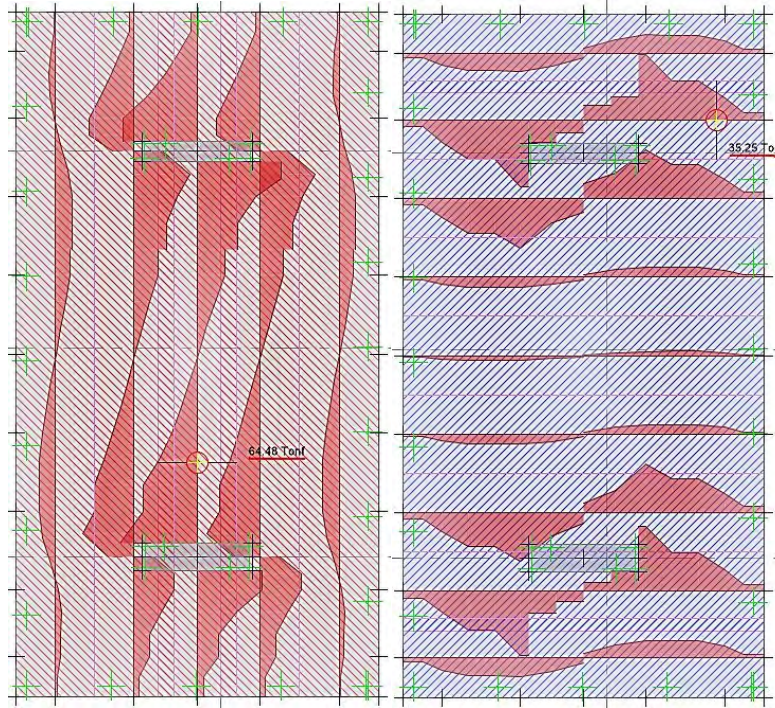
Fuerzas cortantes últimas a distancia "d" del elemento vertical, correspondientes a franjas de diseño longitudinales y transversales, en cimentación para las placas PL06 y PL07
